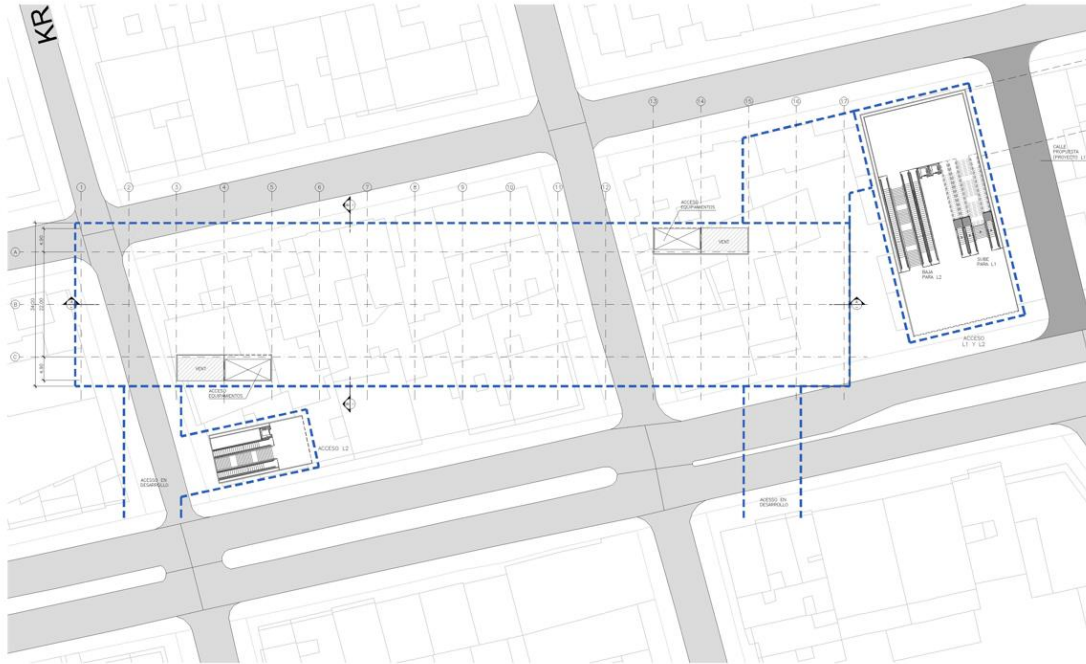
Planta Estación 1 Nivel Calle (0,00)
